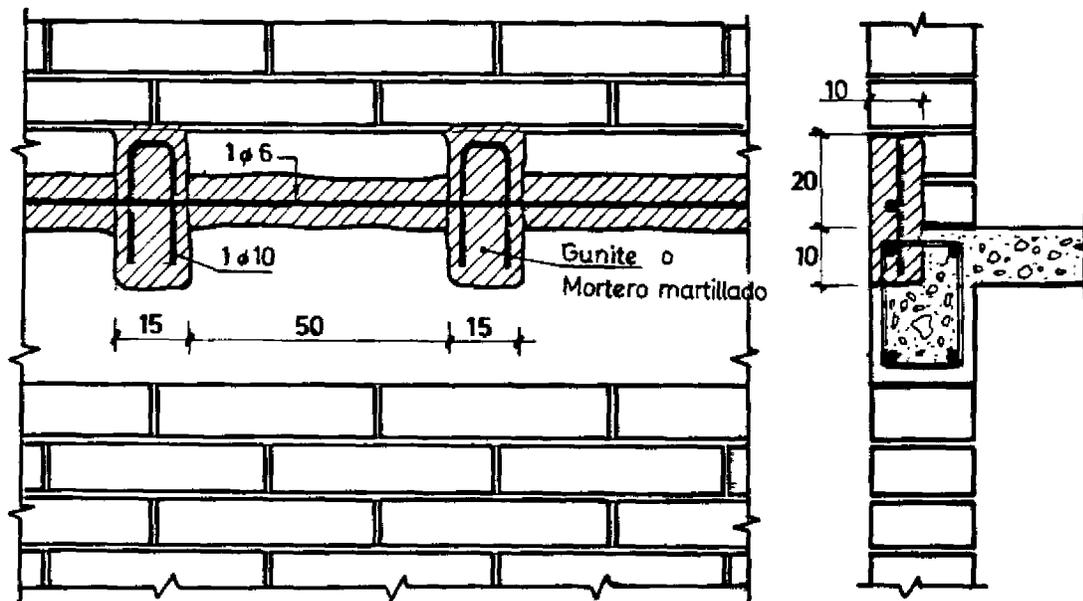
Caso U-1. REPARACION DE UNION DE UN MURO DE ALBAÑILERIA DE LADRILLO DE ARCILLA, CON ELEMENTO DE HORMIGÓN ARMADO (uso de mortero martillado o Gunite)
